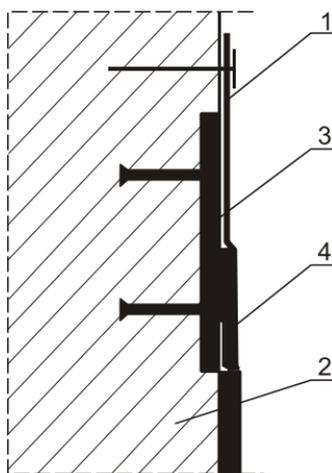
Крепление материалов «Trocal» к основанию с помощью специального соединительного ПВХ-профиля: 1 — защитная мембрана «Trocal TS» или геотекстиль, прикрепленный механически; 2 — конструкция стены; 3 — соединительный ПВХ-профиль; 4 — гидроизоляционная мембрана «Trocal»
